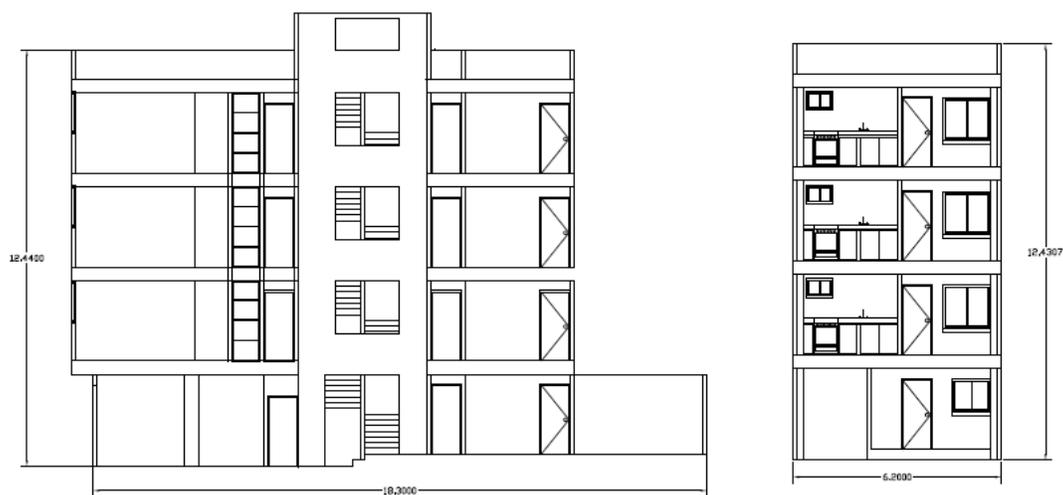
Planos arquitectónicos. Cortes (Fuente Propio)
